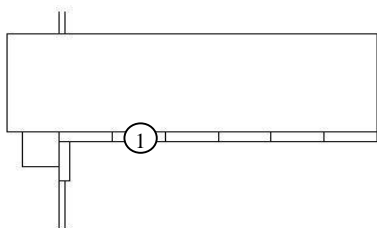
Pormenor construtivo esteira simples (Ramos, 2009).
